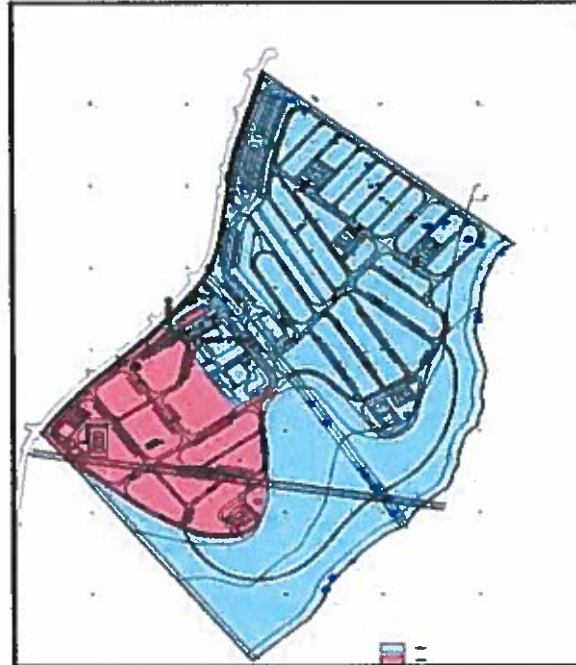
Fases de construção. Azul-fase1; Rosa-fase2 (Fonte: Planta geral da Proposta, vol. IV, Desenho n.º 003)
